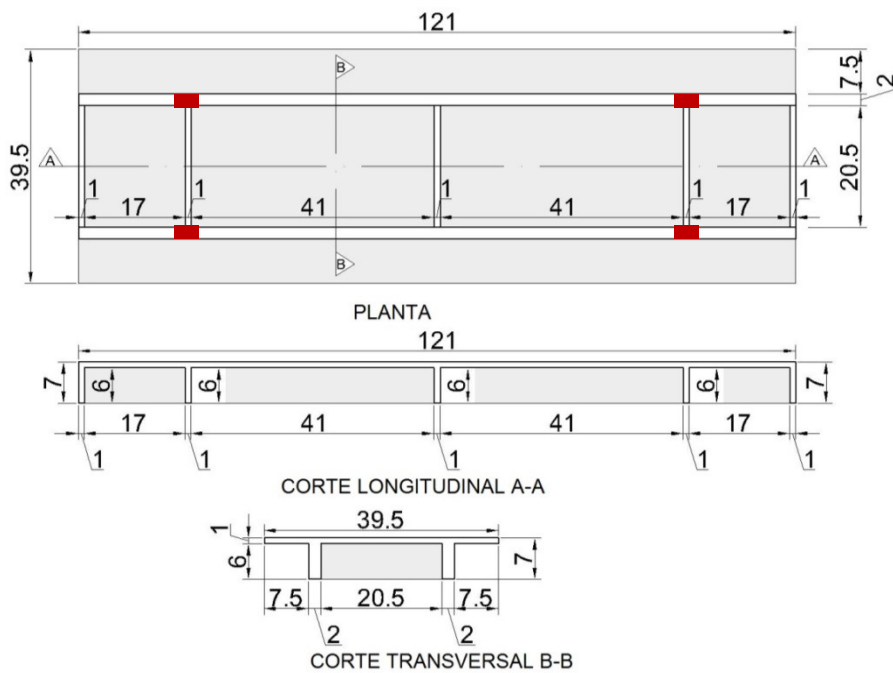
Dimensões em cm da superestrutura dos modelos em escala 1/20
